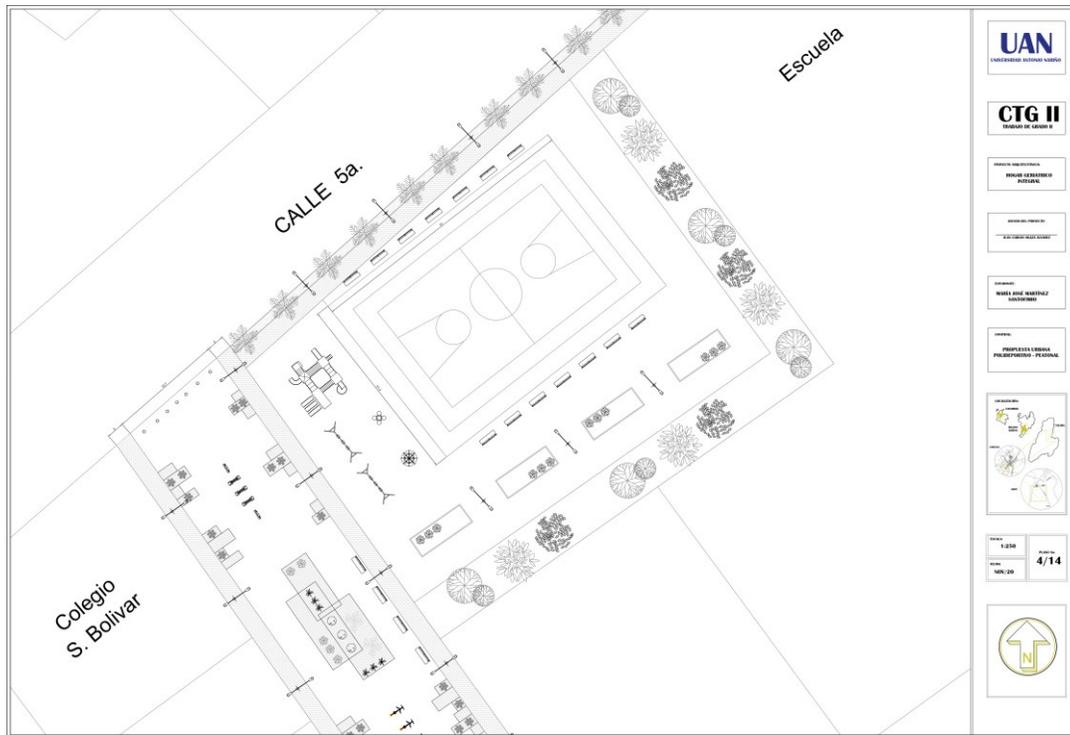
Planimetría Polideportivo y Peatonal. Fuente. Autoría Propia.
